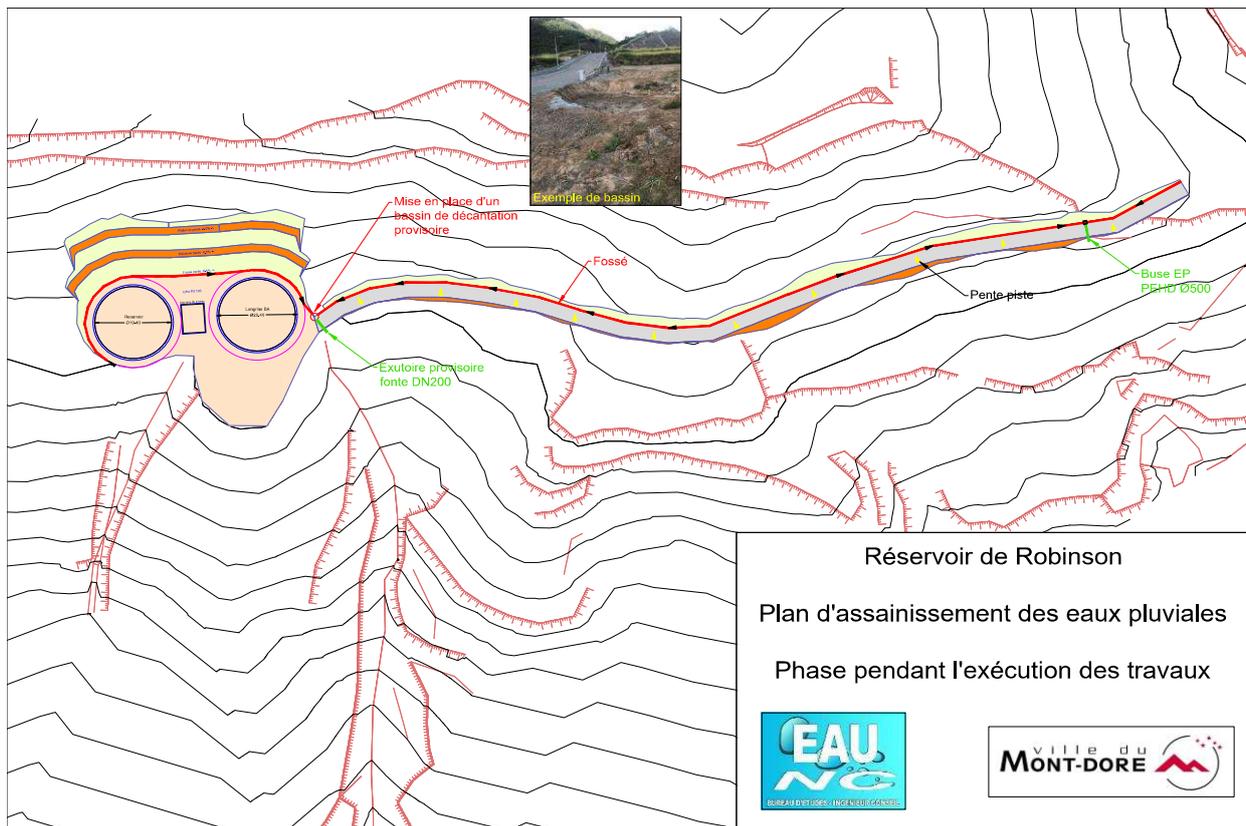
plan de gestion des eaux de ruissellement – phase travaux (Eau NC, 2020).
